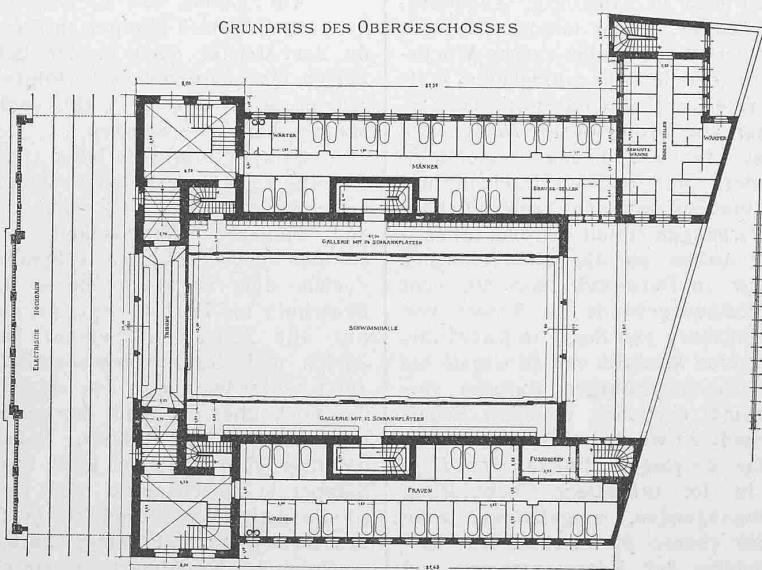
Grundriss vom Obergeschoss des Volksbades in der Dennewitzstrasse. — 1:500.
